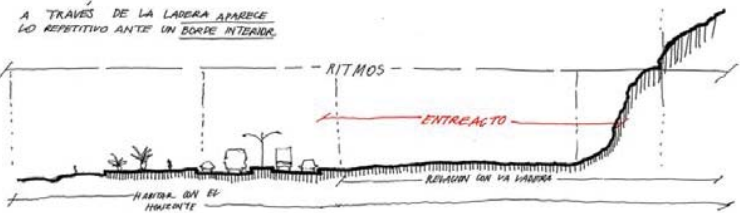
Corte esquemático Master plan las Salinas. Fuente elaboración propia
